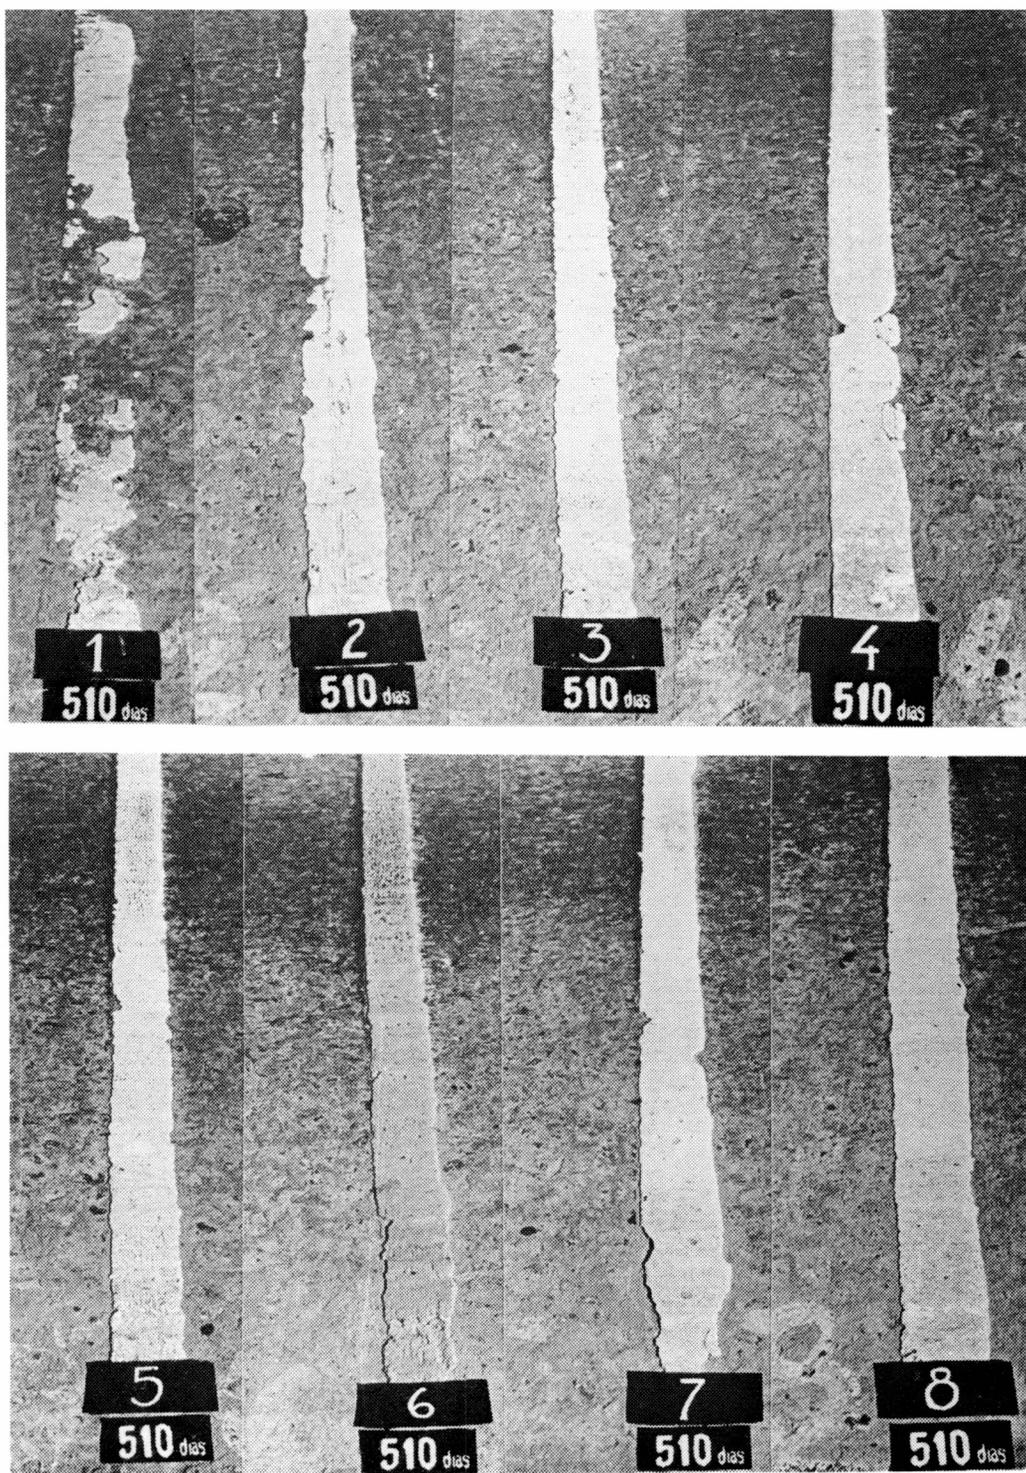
Termoplásticos aplicados sobre pavimento de hormi-
